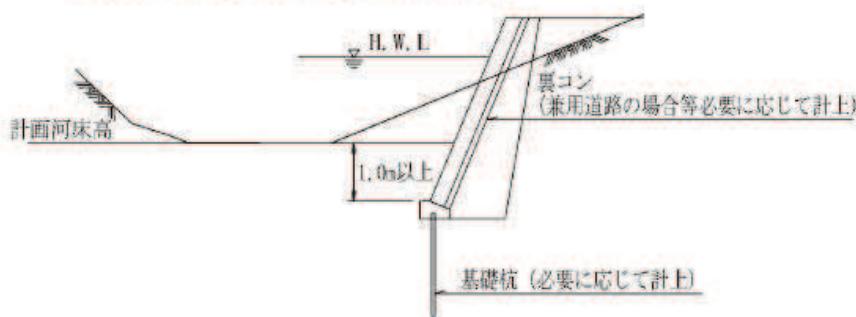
護岸基礎の根入れ(土砂礫の場合)
